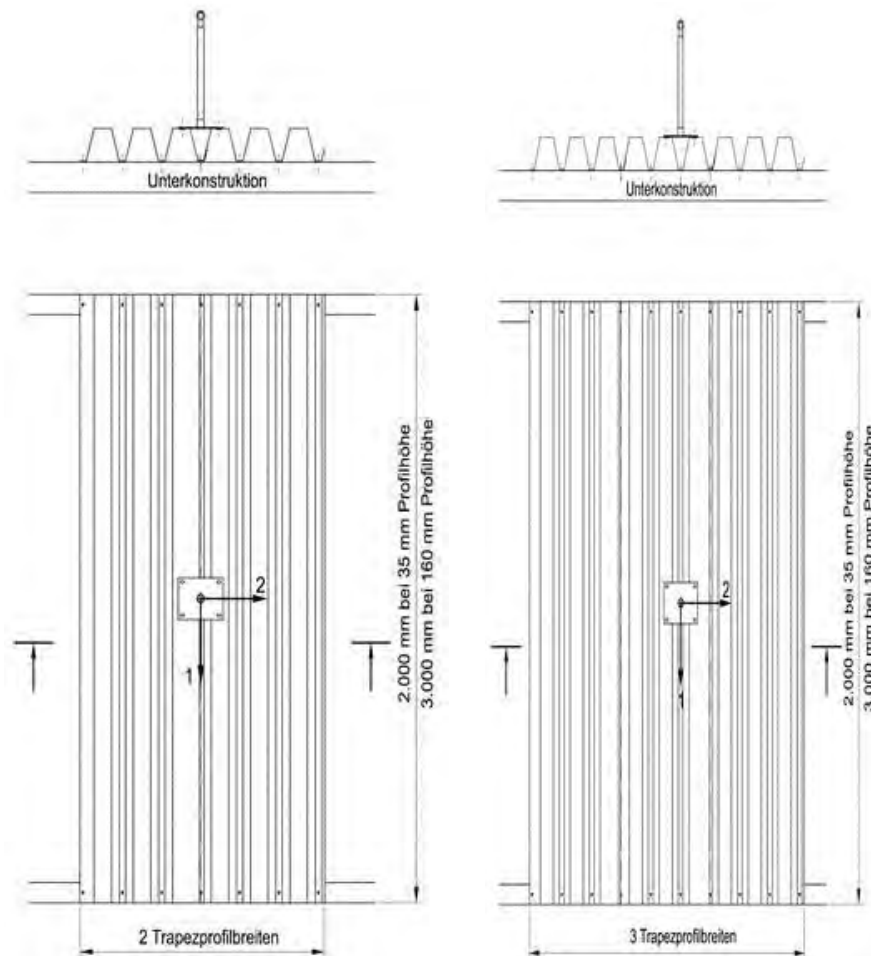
Anwendungsbereich auf Stahltrapezprofil (Positivlage)
